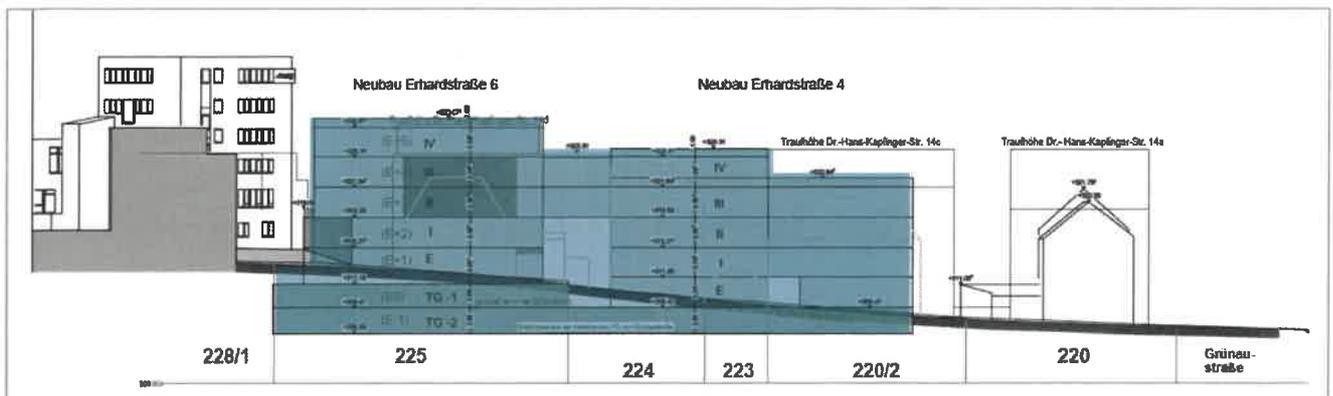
Lageplan inklusive Neubauten, Quelle: Friedl und Partner Architekten
